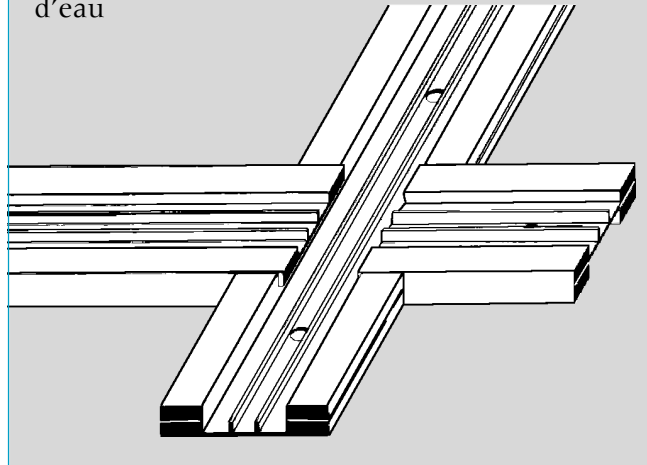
Joint soudé ou vulcanisé aux angles
